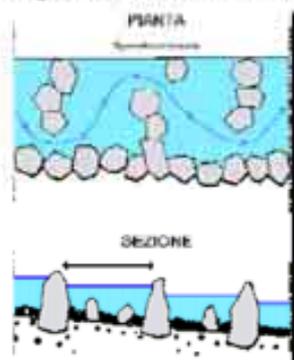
Esempio di rampa in pietrame in pianta e in sezione
